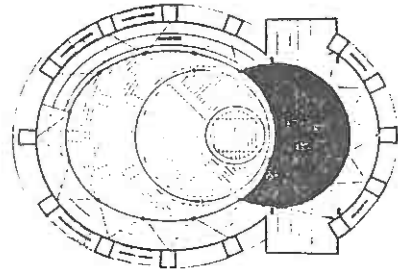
Plan du Colisée, d'après Leveil (Gailhabaud).
